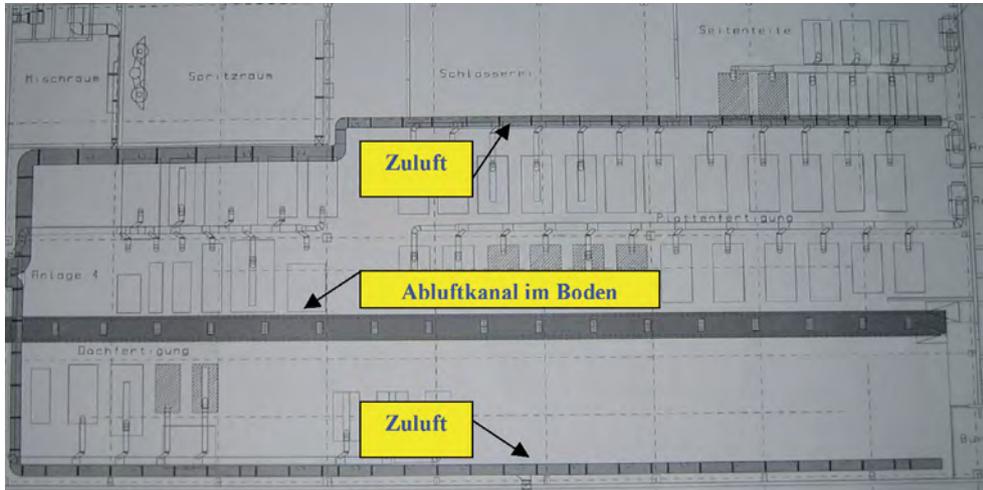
Grundriss einer Fertigungshalle mit raumlufttechnischer Anlage (RLT-Anlage) ohne Absaugung
